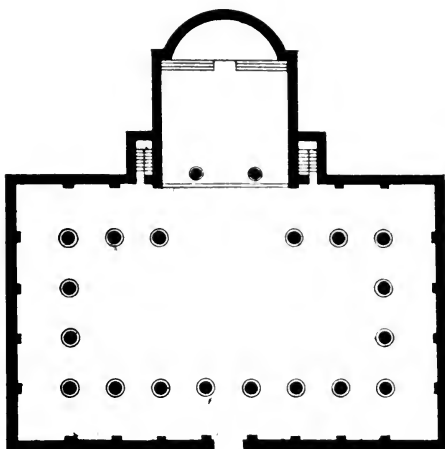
PLAN DE LA BASILIQUE DE FANO.
